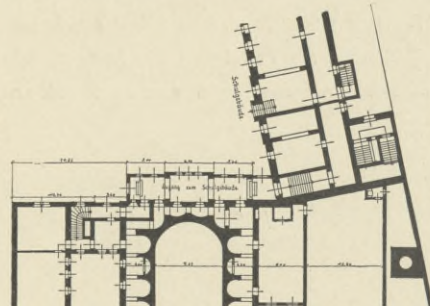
(Grundriß des Verbindungsganges der Badeanstalt mit dem Schulgebäude a. d. Wilsmsstraße.)
